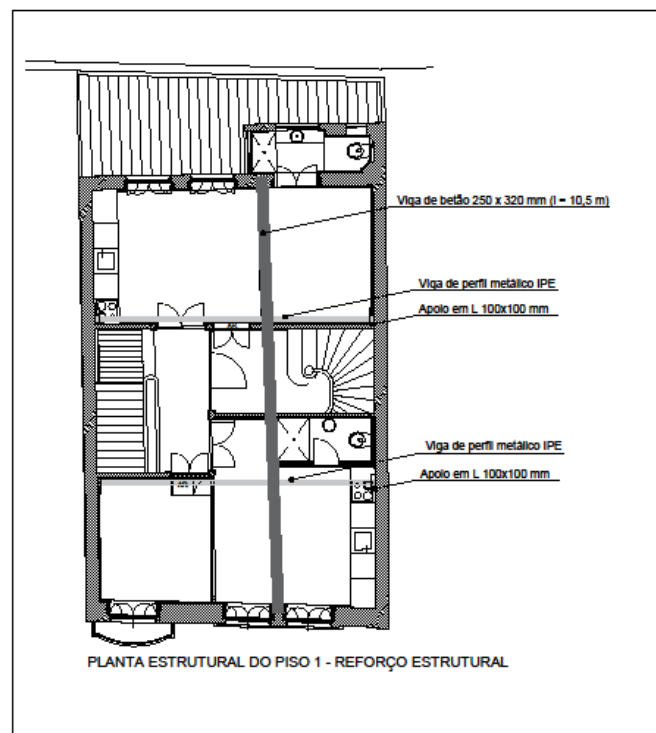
Planta estrutural do Piso 1 - Reforço estrutural
